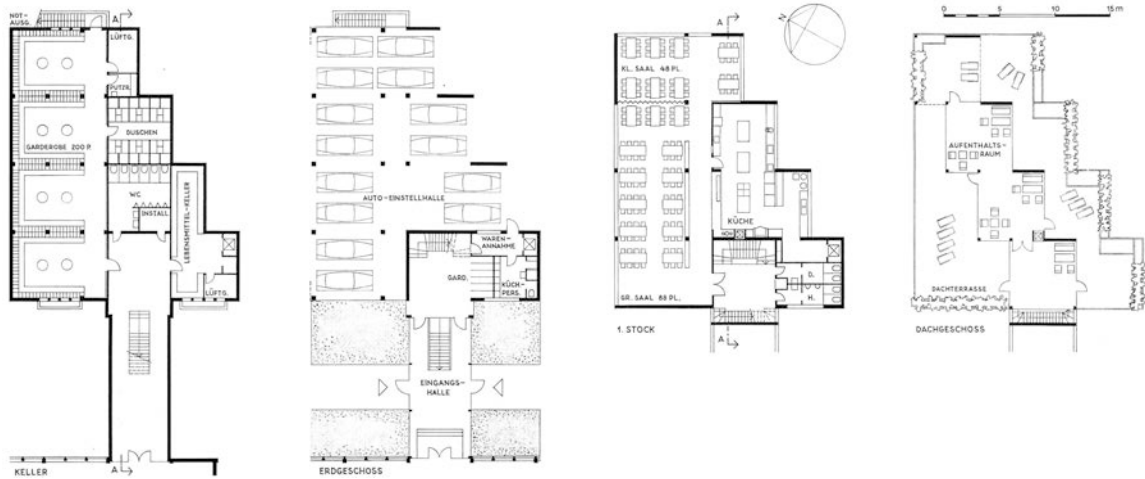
Wohlfahrtsgebäude Grundrisse. (SBZ, Heft 24, 1964)
